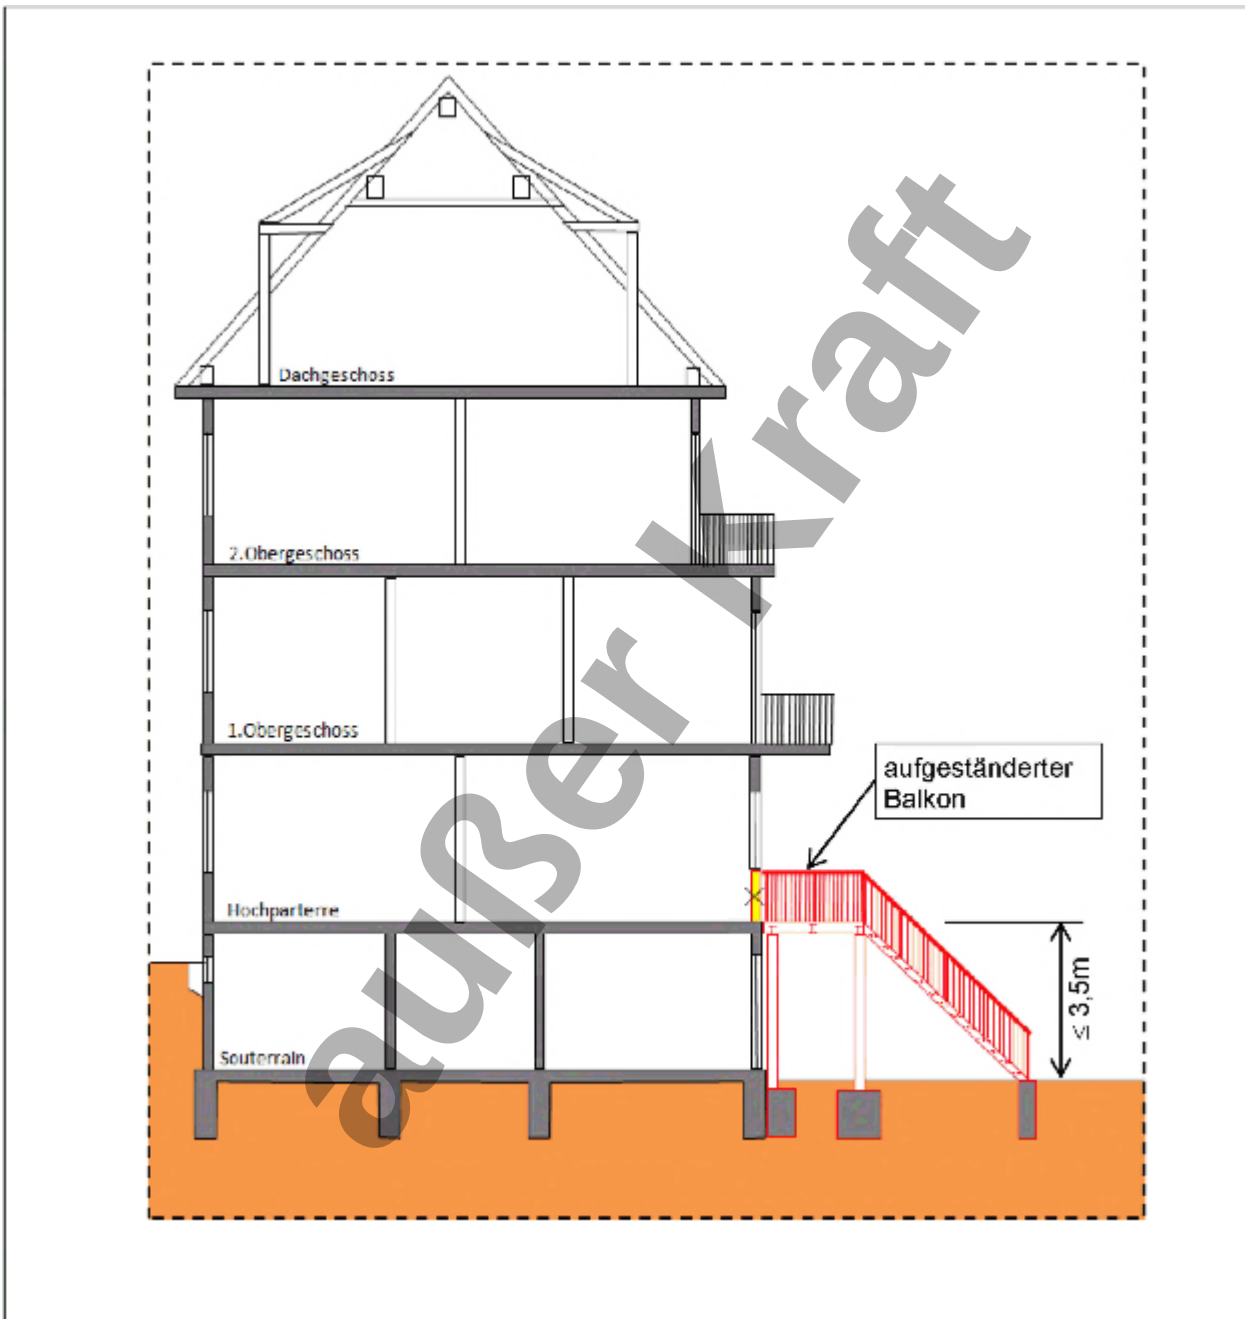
nachträglicher Anbau von eingeschossigen Balkonen
